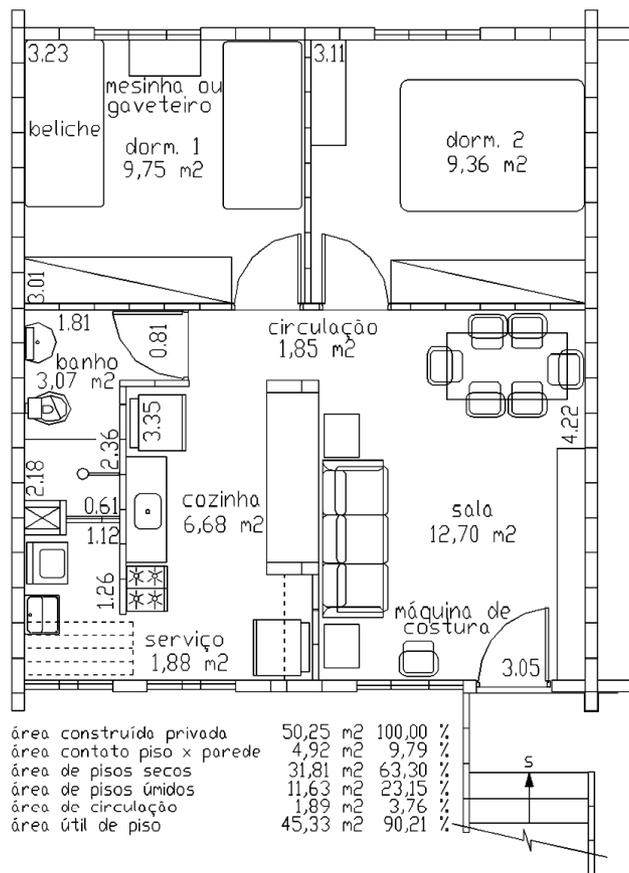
Planta 7 – Projeto alterado, com área expandida e manutenção da organização do setor hidráulico
